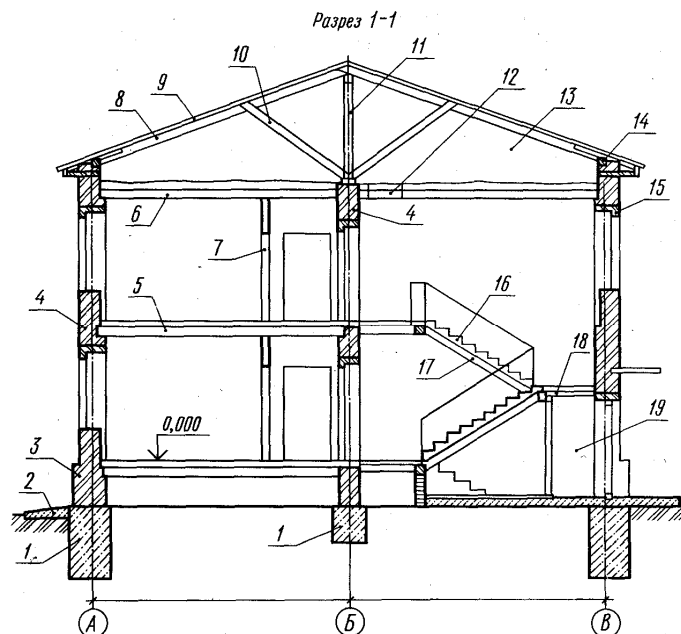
Конструктивні елементи будівлі із стінами, що несуть:
